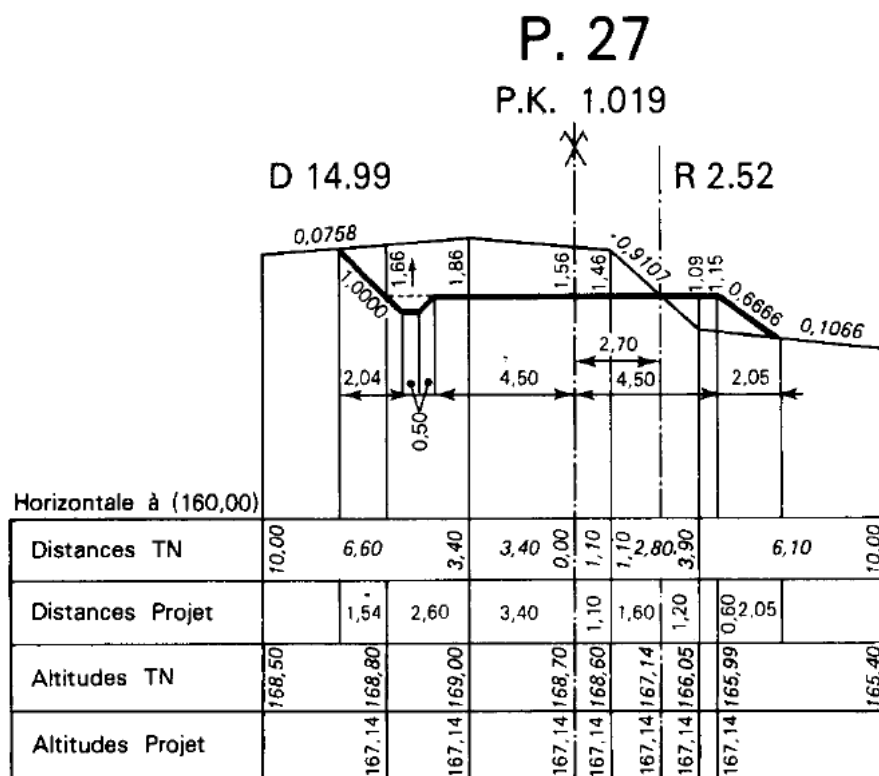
Terrassements selon le profil en travers d'un projet routier.
